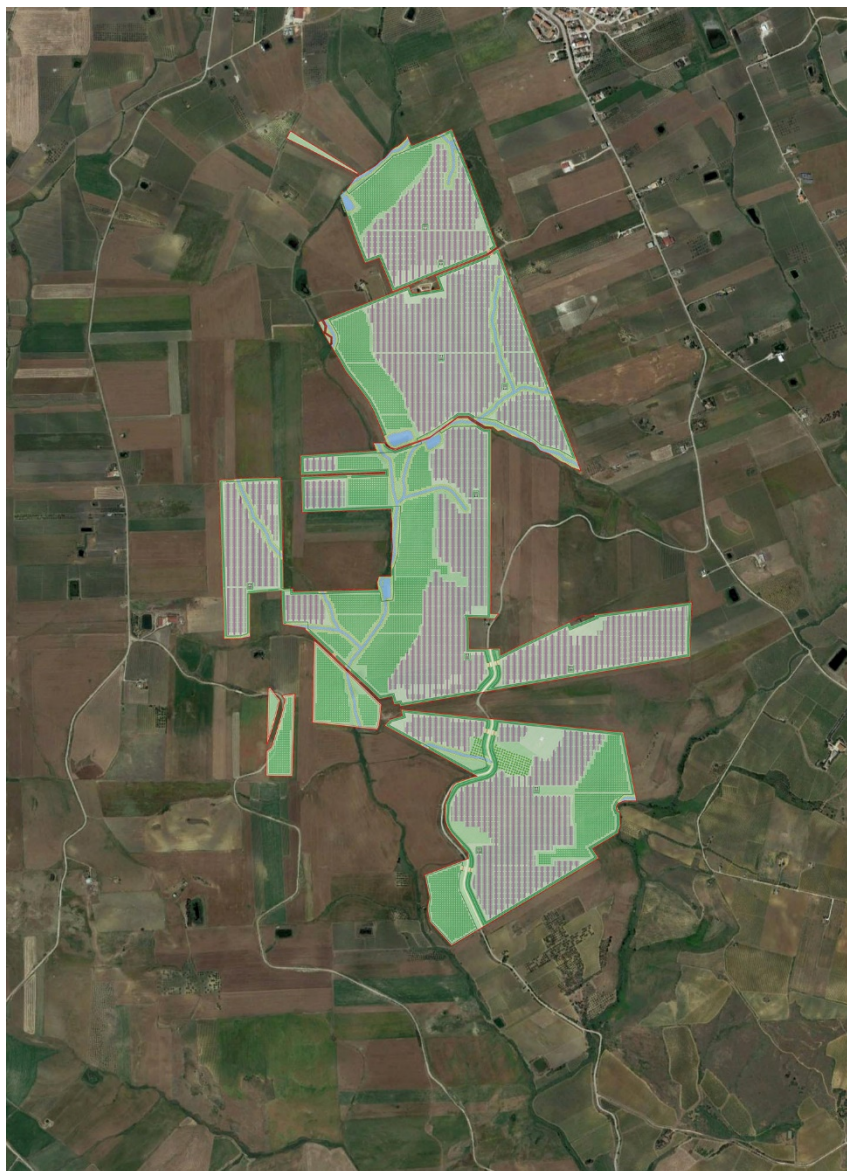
B – Layout su ortofoto dell’area d’impianto ricadente nel territorio di Camporeale – Monreale (PA) -Contrada Mandranova
